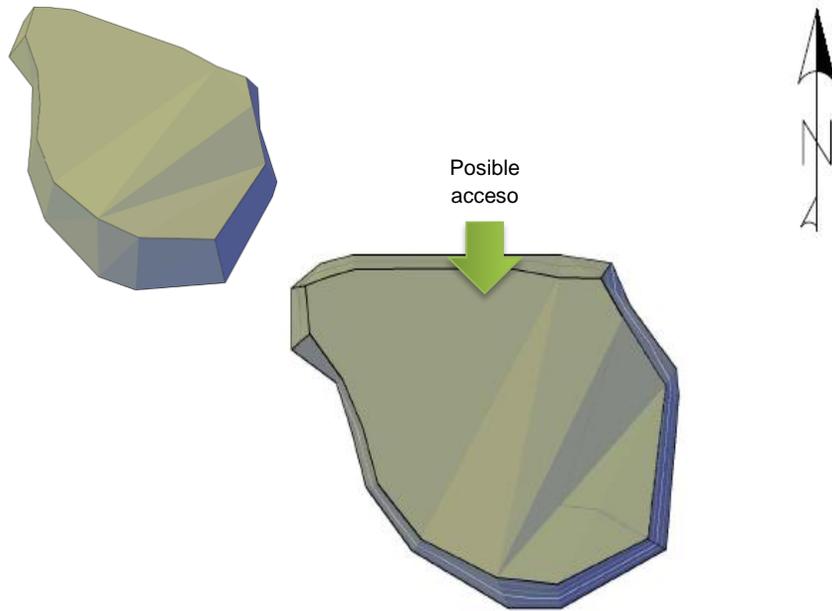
Perspectiva y vista de planta de la Estructura 7.
